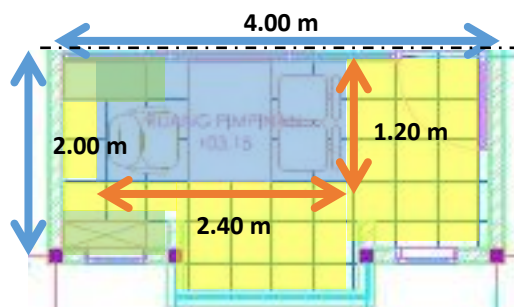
Denah Ruang Kerja Lantai 2 Objek B
